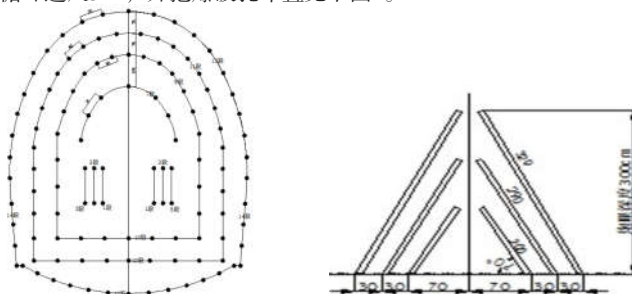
Ⅲ级围岩全断面法施工开挖爆破孔布置图及平面八字掏槽爆破孔
